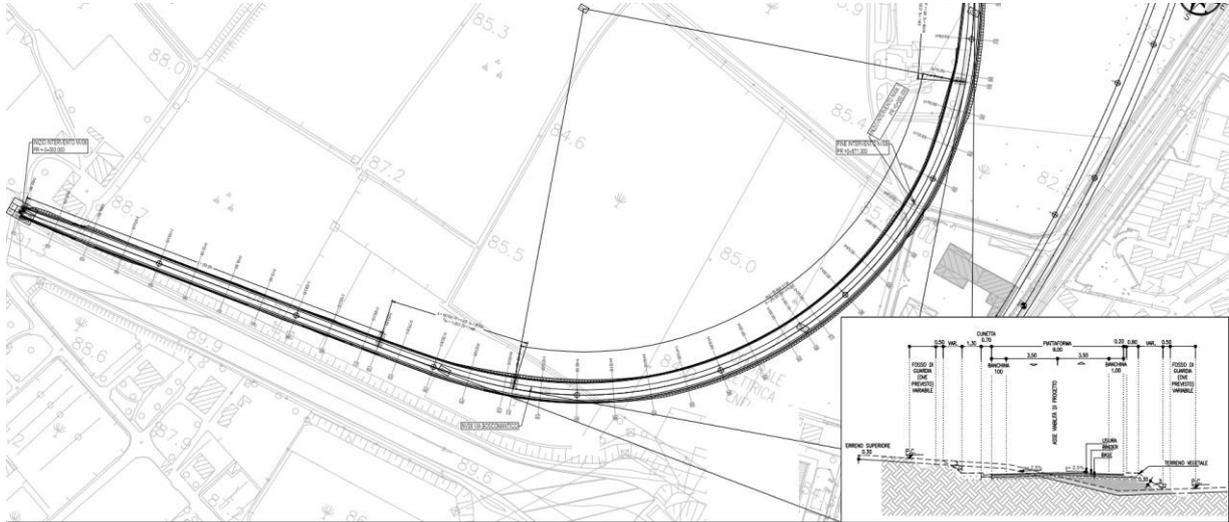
NV08 - Stralcio planimetrico su rilievo Via A.A. Berardi (A)
